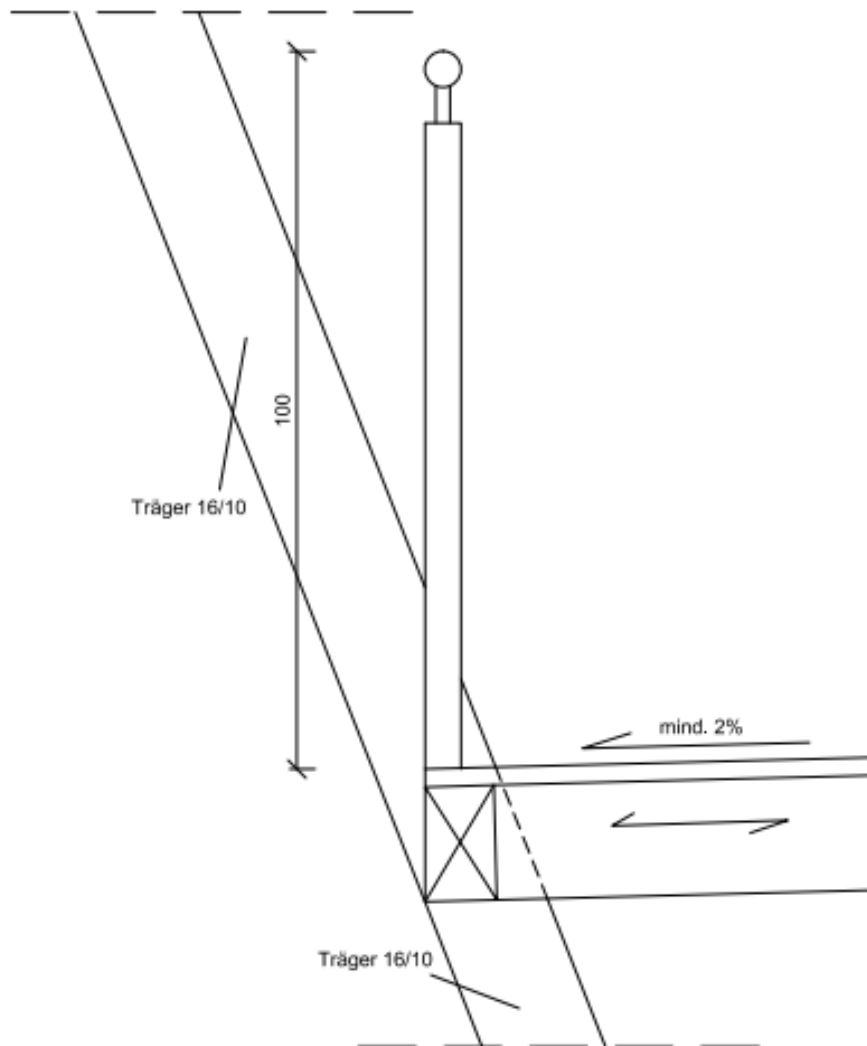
Detail 04 - vorderer Anschluss Terrasse
